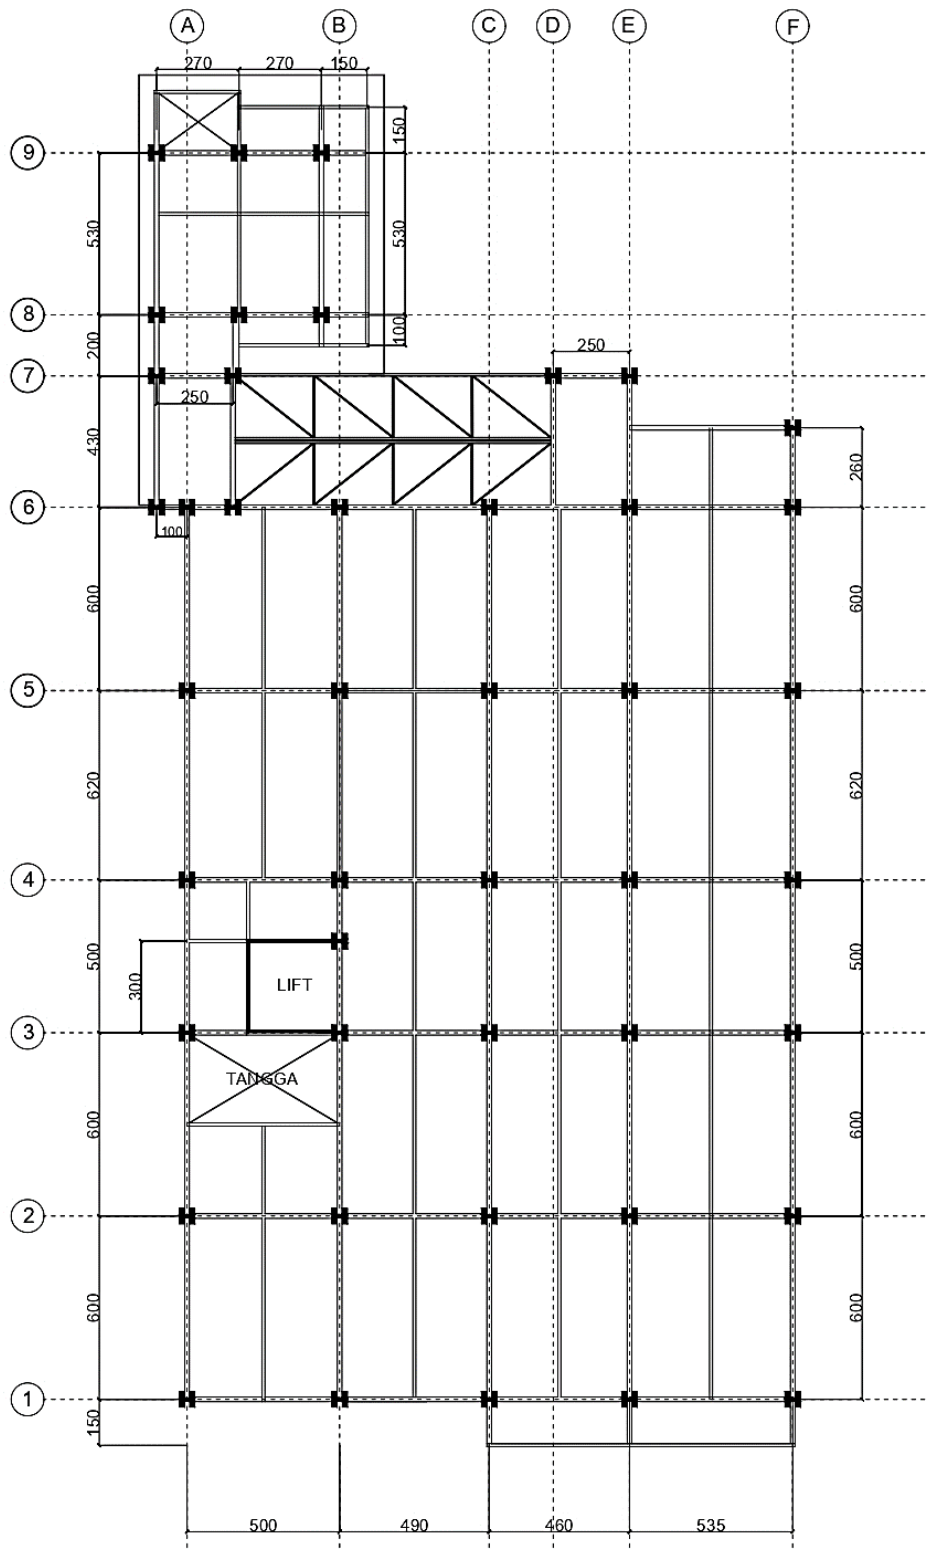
Gambar Denah Sloof dan Kolom Lantai 1
